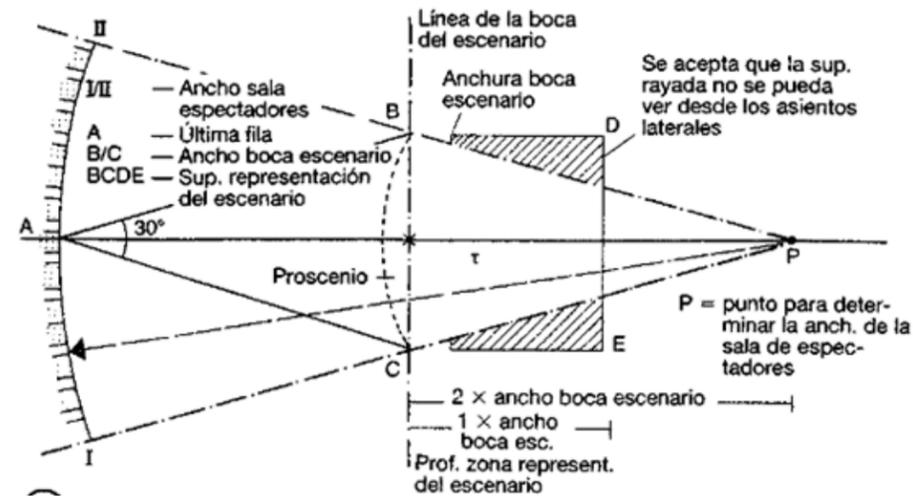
Proyección de anchura de la sala. Fuente: Arte de proyectar en arquitectura.
